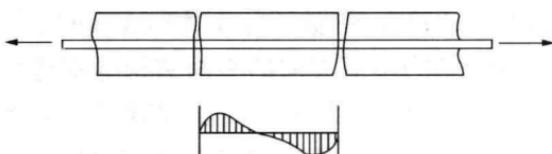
钢筋和混凝土之间的粘结应力示意图（对）
